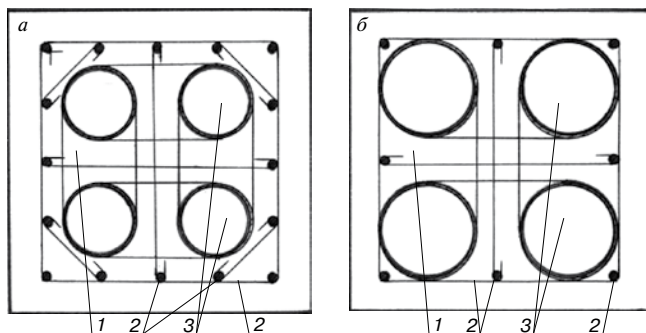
Варианты поперечного сечения колонны 900×900 мм с четырьмя трубобетонными элементами круглого поперечного сечения: 1 – бетон; 2 – гибкая арматура; 3 – трубобетонные элементы
